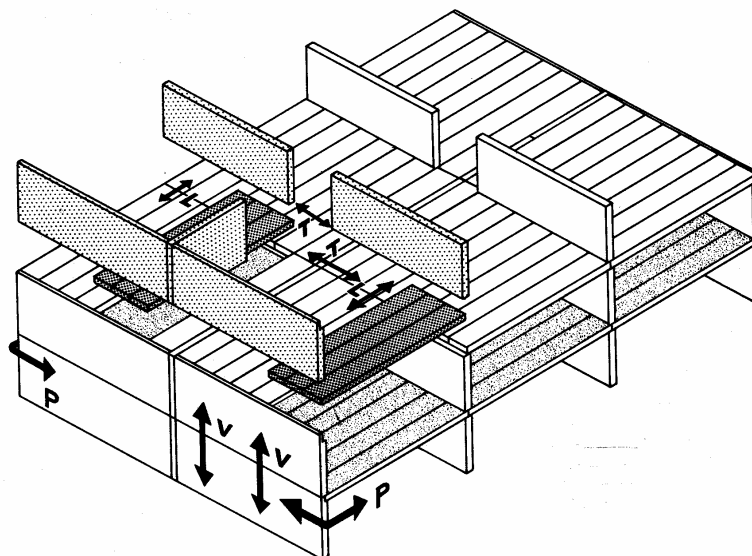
localização esquemática das armaduras de tirantes no sistema de paredes estruturais
